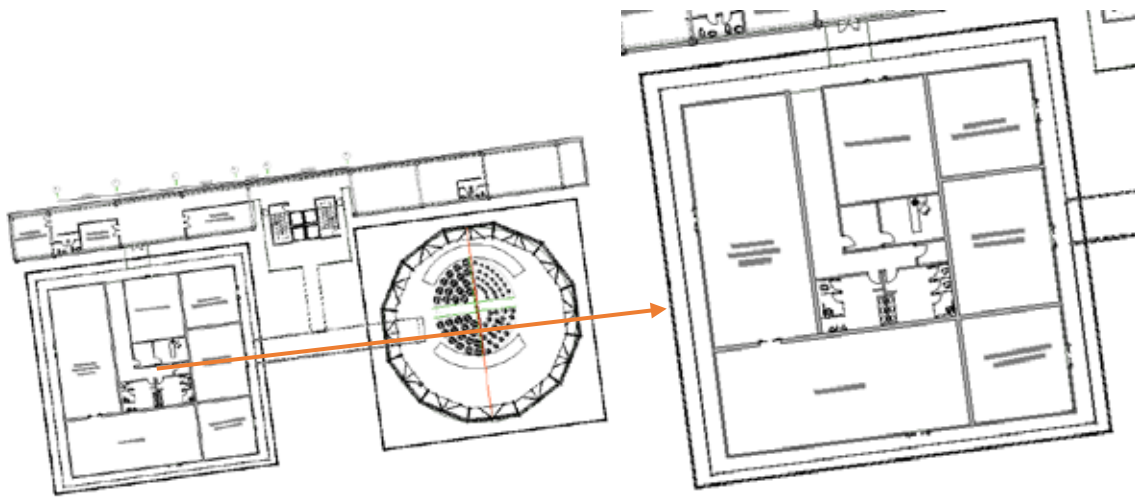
Planta 2 Nivel + 9.50 - Modulo 2. (2016)
